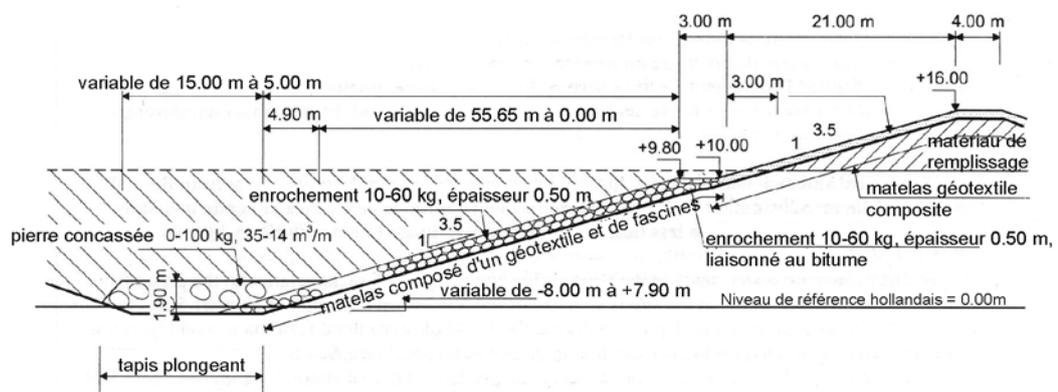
Pied de digue longitudinale munis d'un tapis plongeant construit dans une tranchée (excavée à sec ou draguée sous l'eau, selon les besoins)
